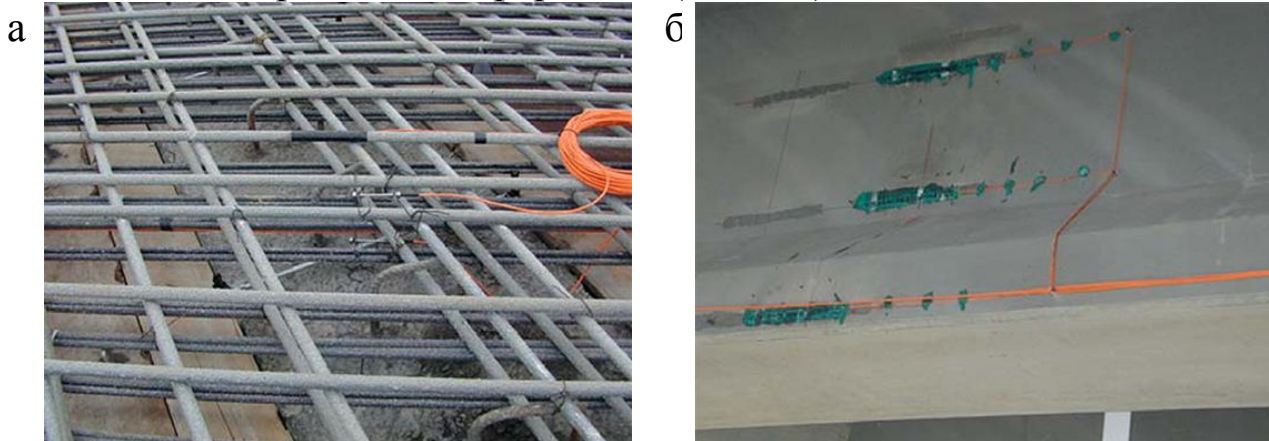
Оптоволоконні датчики: а – вбудовані; б – на бетонних балках
